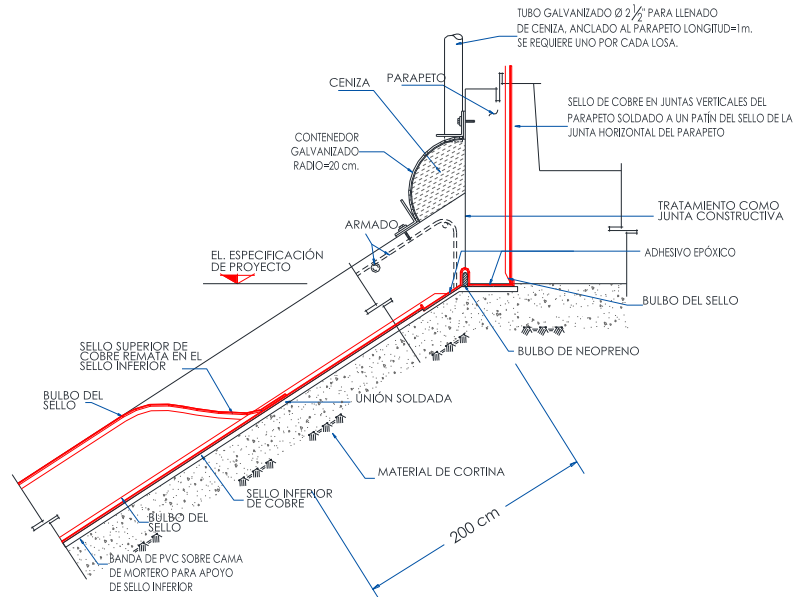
Arreglo típico de la junta flexible entre la cara de concreto y el parapeto (utilizado en P. H. La Yesca)
